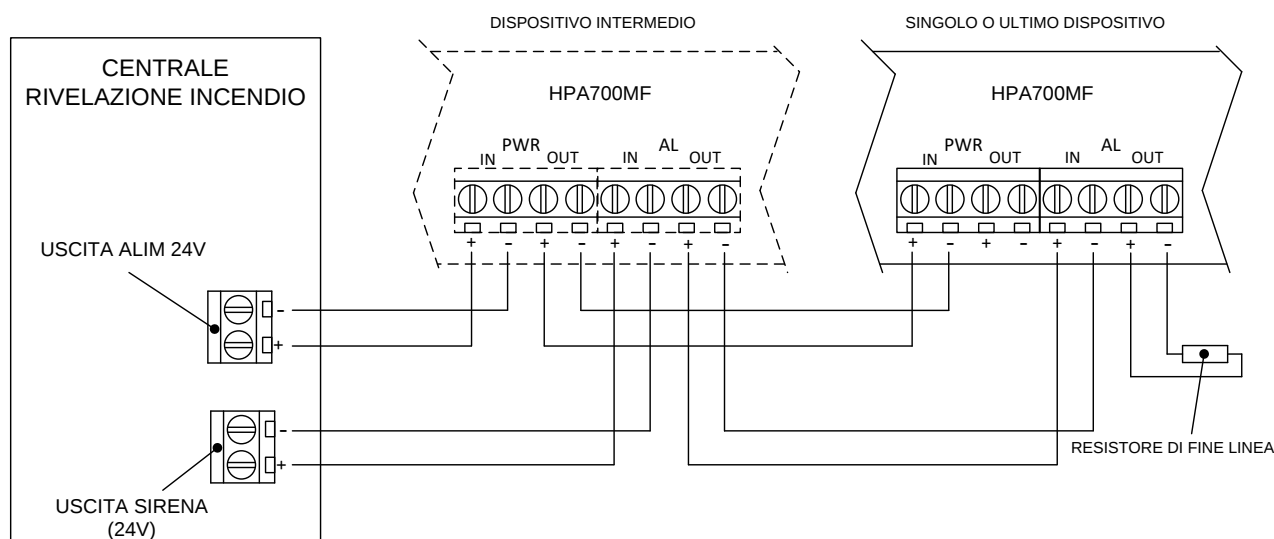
Alimentazione separata della/e sirena/e con pilotaggio dall'uscita segnalazione allarme incendio della centrale
